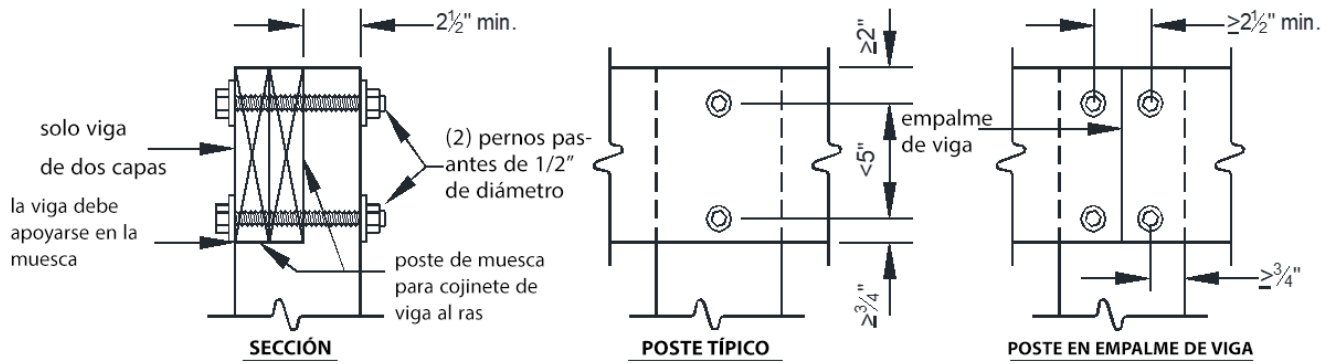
CONEXIÓN DEL POSTE A LA VIGA CON MUESCAS DE 6x6
